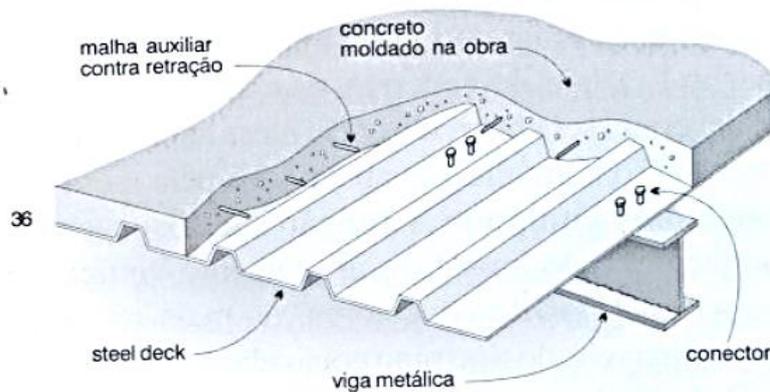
Detalhe laje pré-moldada com viga metálica
